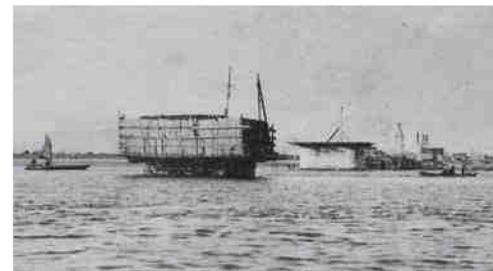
ケーソン躯体の載荷試験の作業状況(吉野川橋工事概要)
